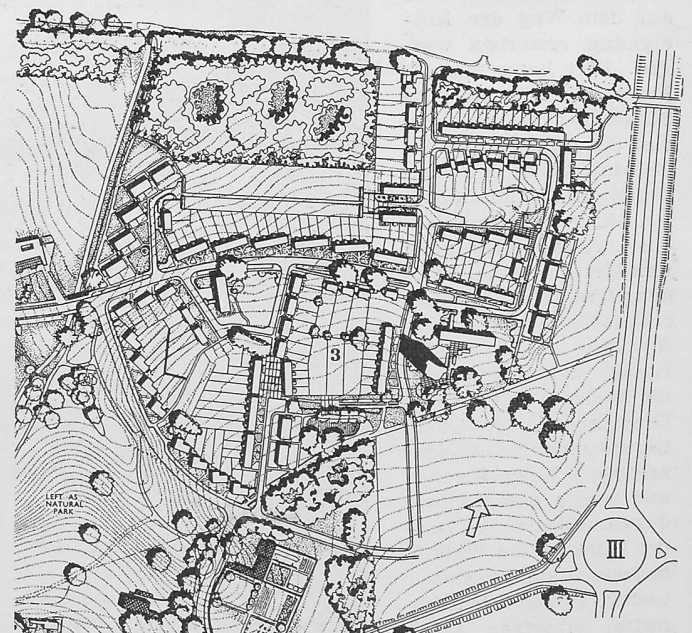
Harlow, Stadtteil Mark Hall, Ausschnitt aus dem Detail-Bebauungsplan
